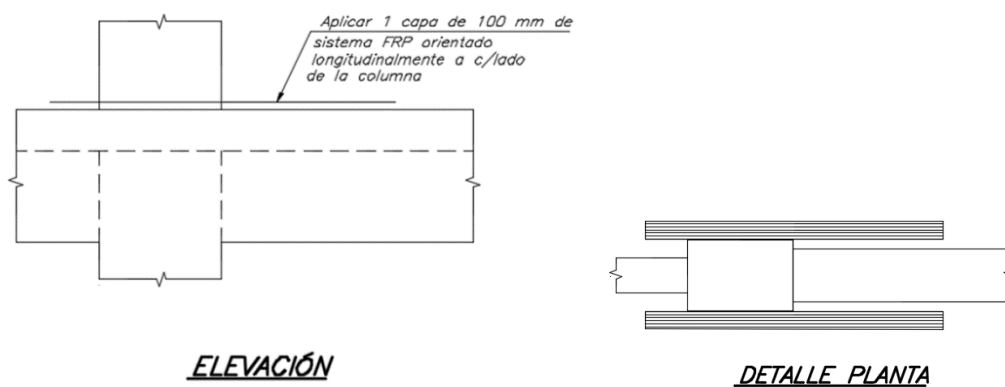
Detalle de refuerzo negativo mediante desarrollo del FRP lateralmente a la columna.
